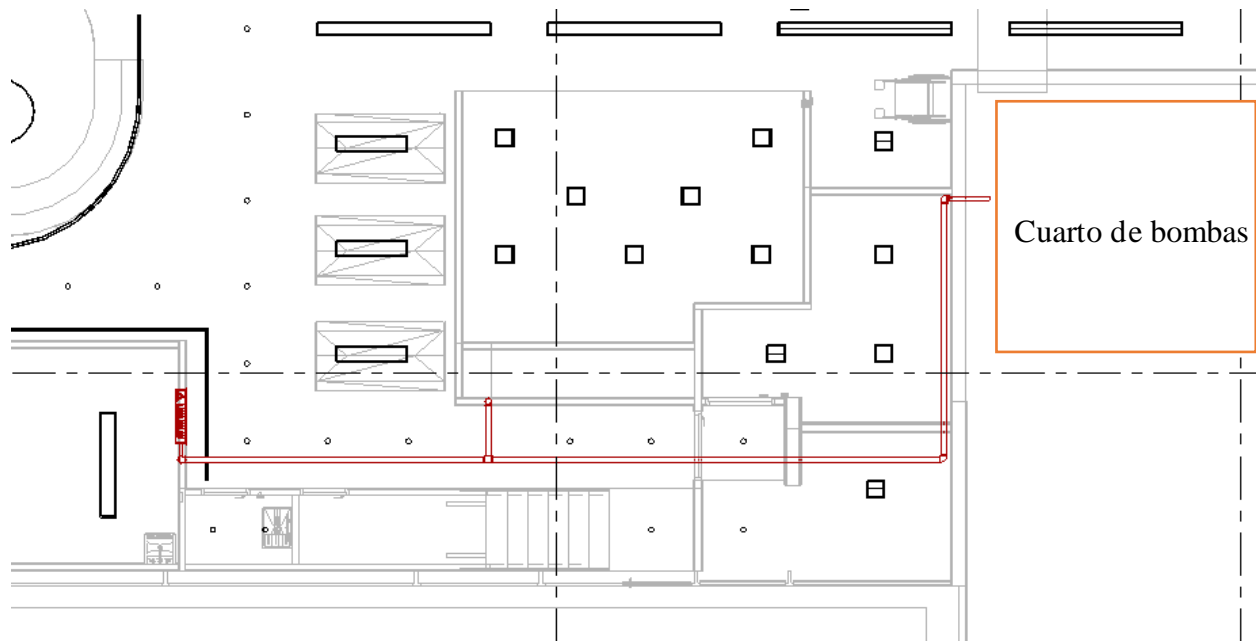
Distribución de tubería. Vista de planta, planta baja.
